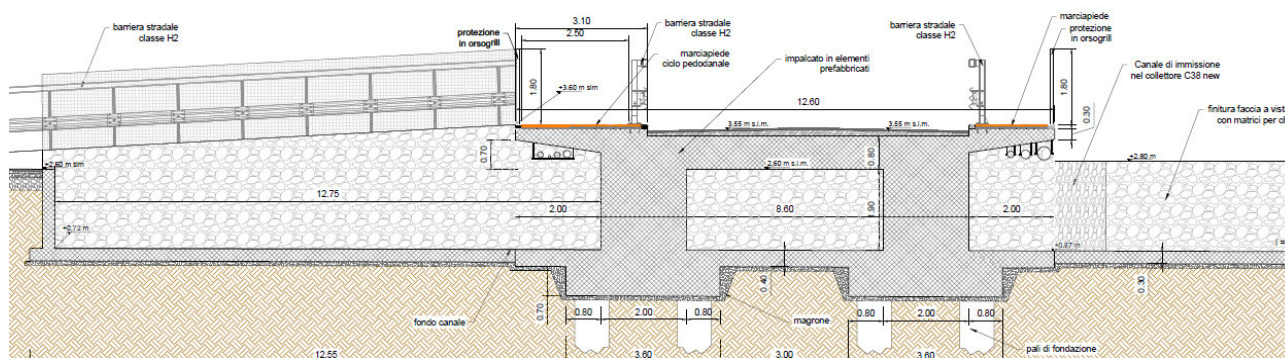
Sezione longitudinale del canale di intercettazione in corrispondenza dell'imbocco e del nuovo attraversamento stradale lungo Via Pisano.
